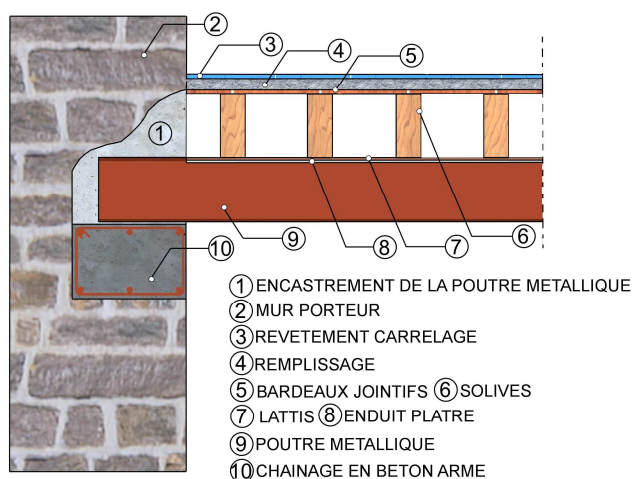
Réparation d'un plancher en bois par soutien des poutres aux appuis.
